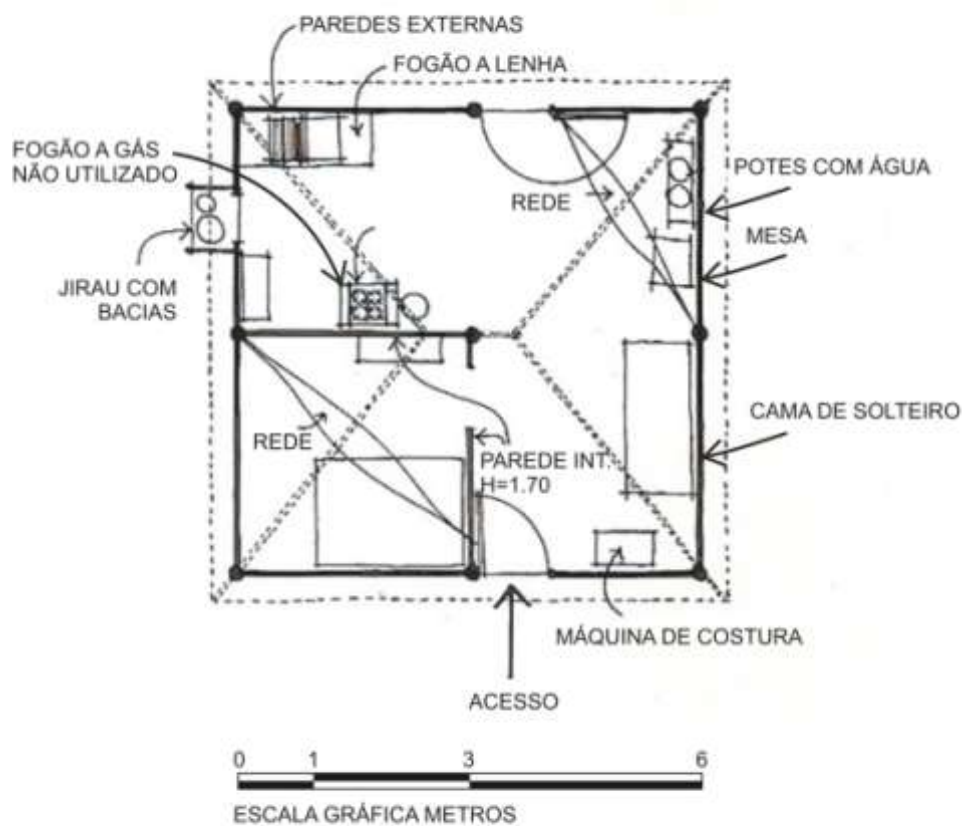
Esquema de planta de uma casa cabocla situada na Ilha do Bananal, próximo à aldeia Karajá, de Santa Isabel do Morro.
